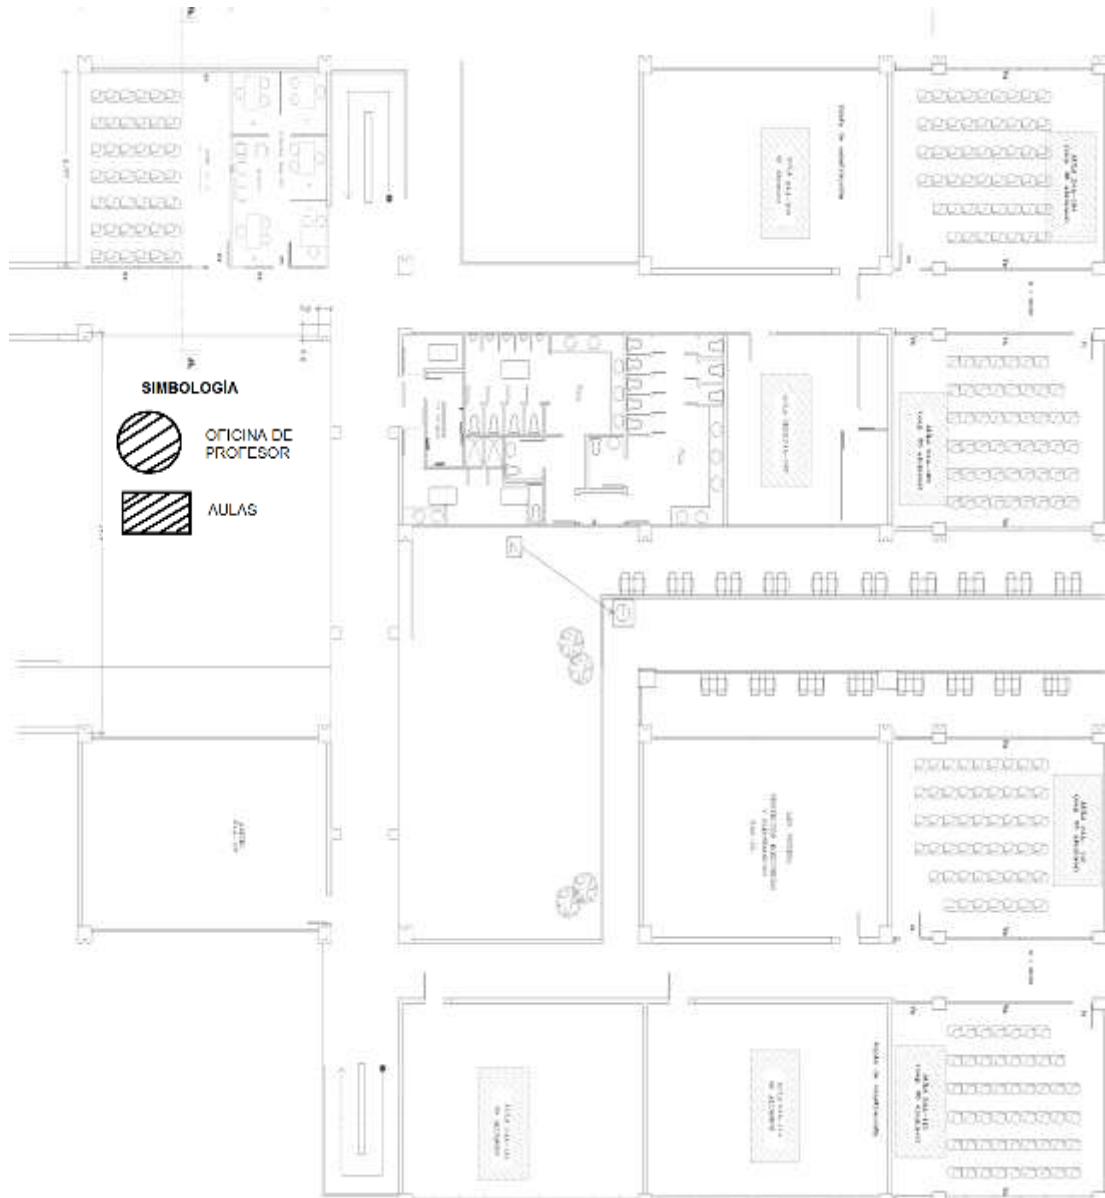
Plano Aéreo del Bloque 16C – planta alta[8]
